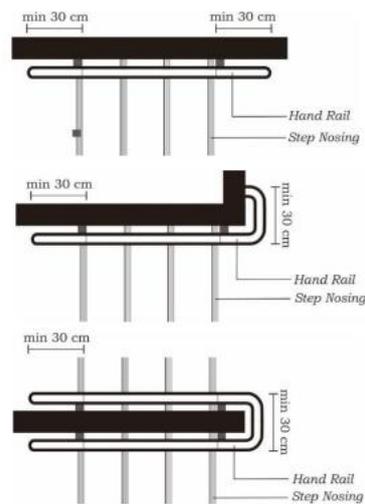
Detail tangga rekomendasi.
